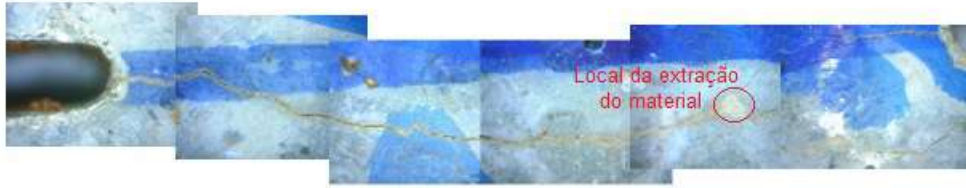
Local de extração do material de preenchimento da fissura
